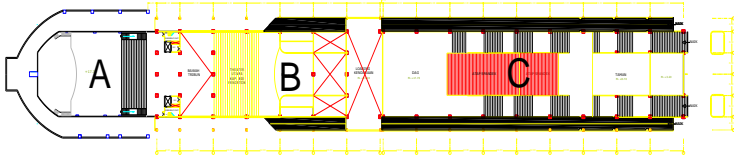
Denah Elevasi +8.70 Taman Budaya Kota Padang
